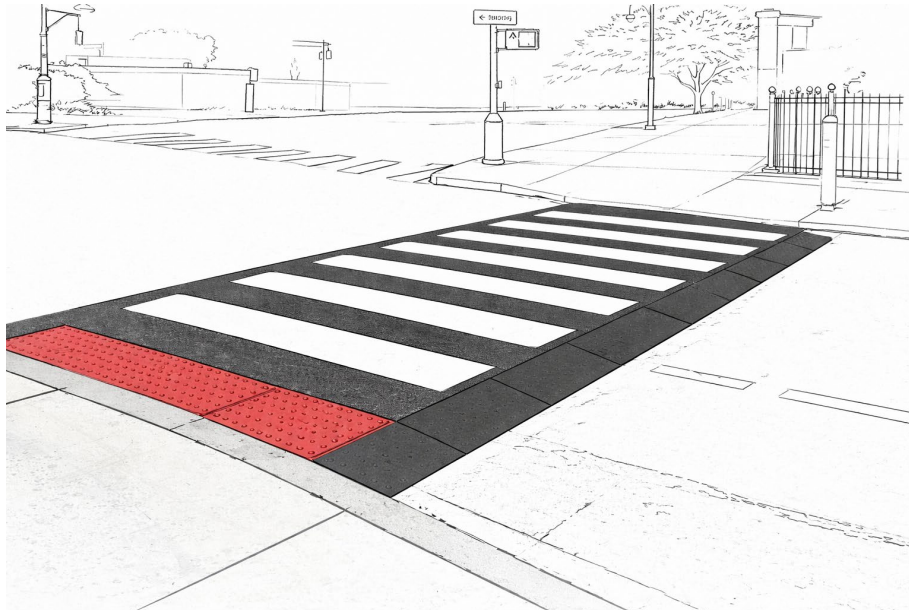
Platformă ridicată pentru trecerea de pietoni
